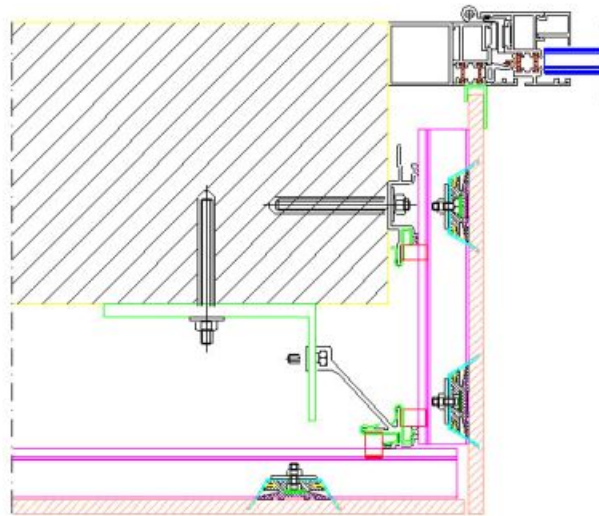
Aplicação da fachada ventilada – Remate da janela com sistema oculto [48]
